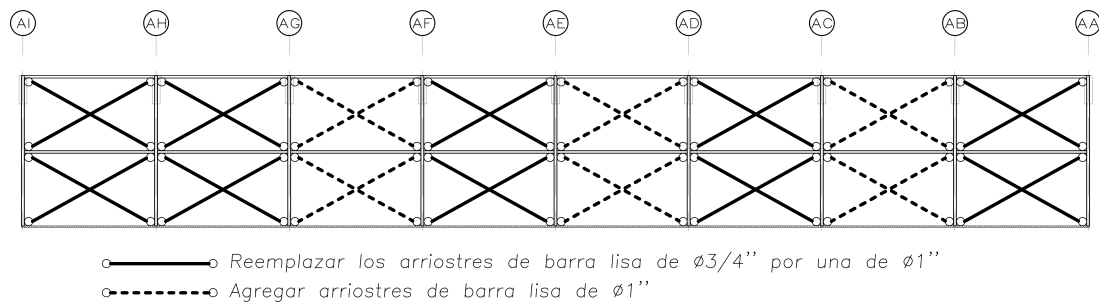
Propuesta de reforzamiento de la estructura en la dirección Y, Eje 3
